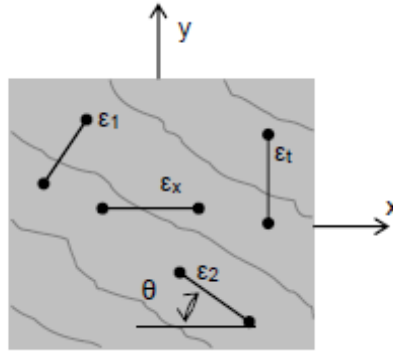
Deformaciones medias en un elemento fisurado.
